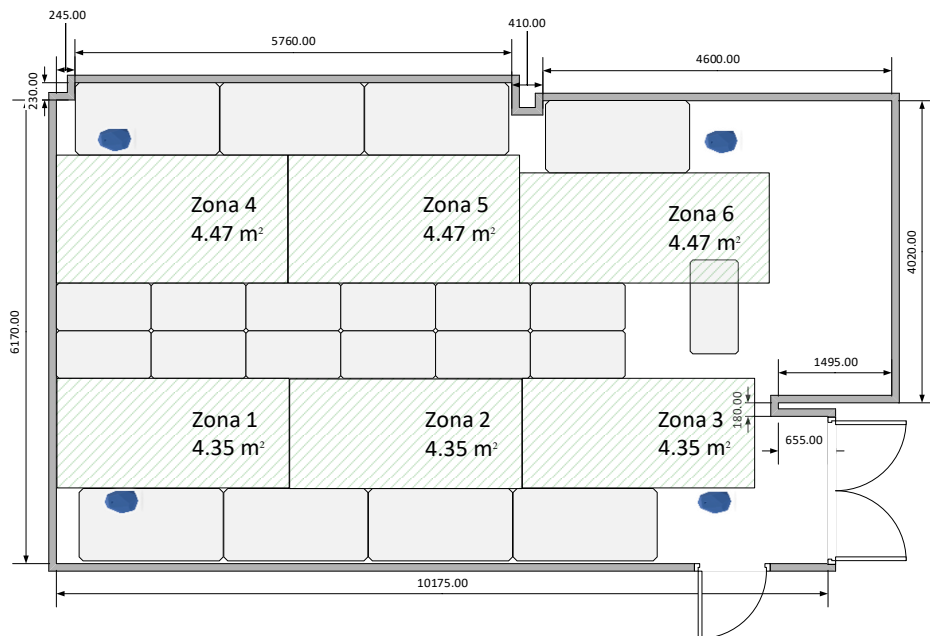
Área de trabajo con 4 beacons, ubicación en el techo.
